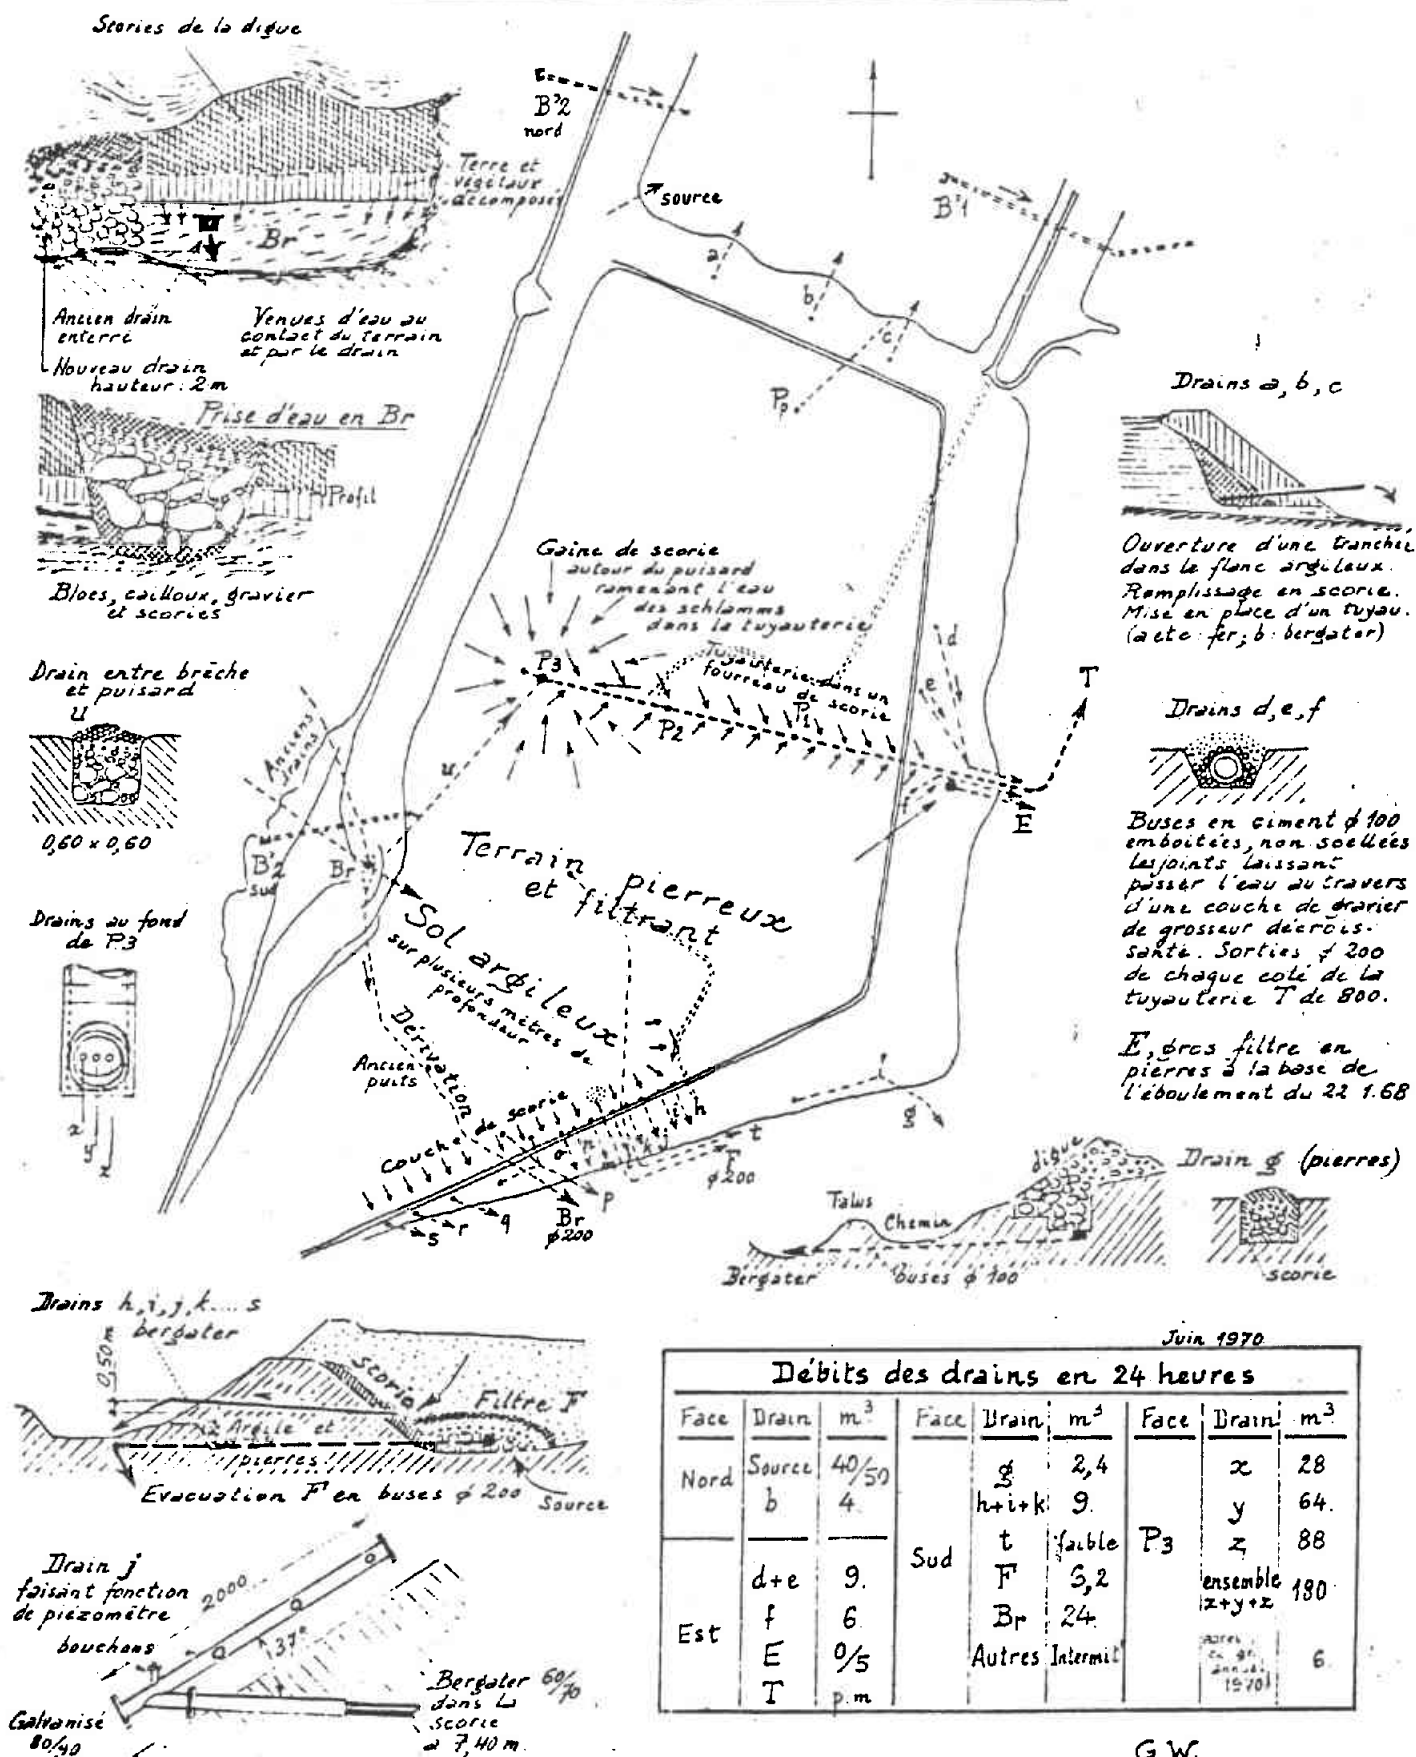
Système de drainage de la plage B4 (d'après G. WEISSER)
